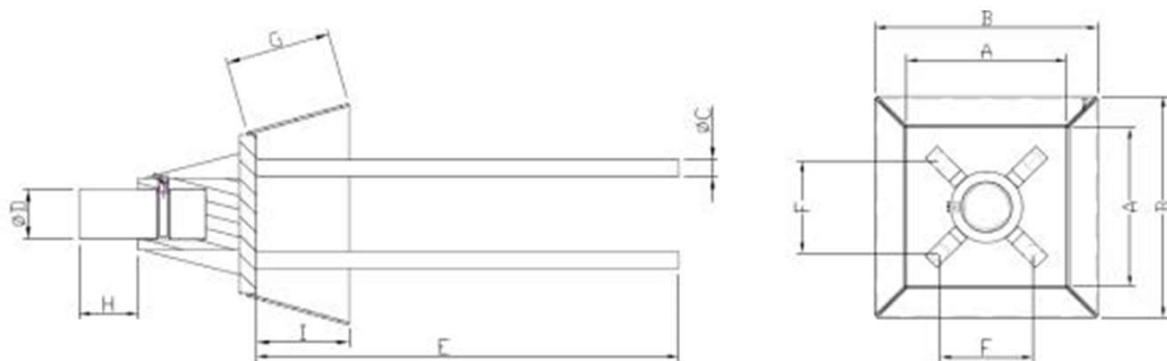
Detail zámku pilótovej spojky pre prefabrikované pilóty z betónu
